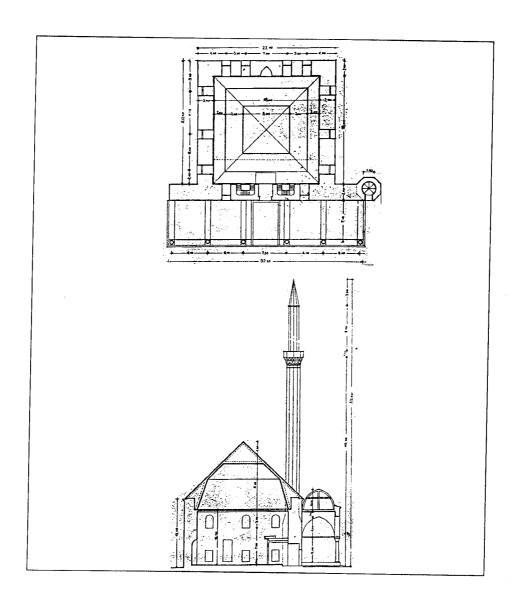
مسقط أفقي لمسجد الدفتردار (الأرناؤوطية) في بانيالوكا (عن : ايفردى) .
